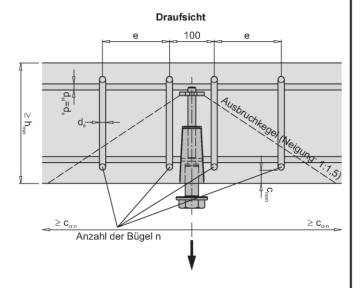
Einbausituation in dünne Wände - Zugbeanspruchung mit Rückhängebewehrung - Bewehrungslage
